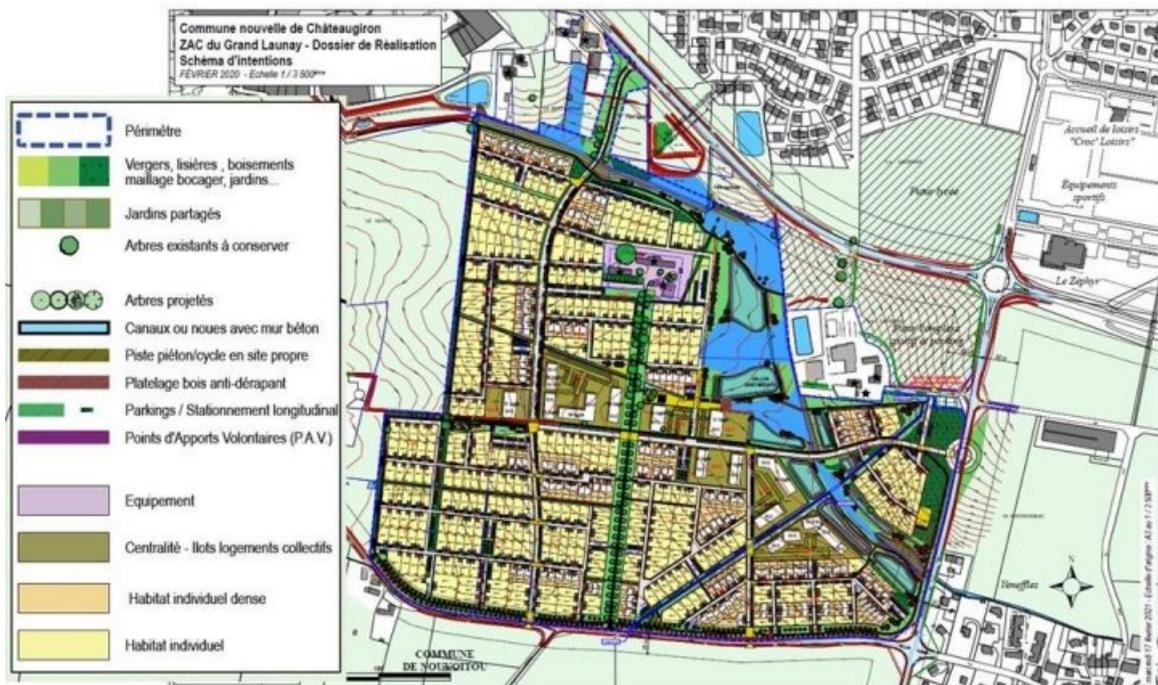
plan de masse du projet au stade de l'avant-projet (dossier pièce 5)
